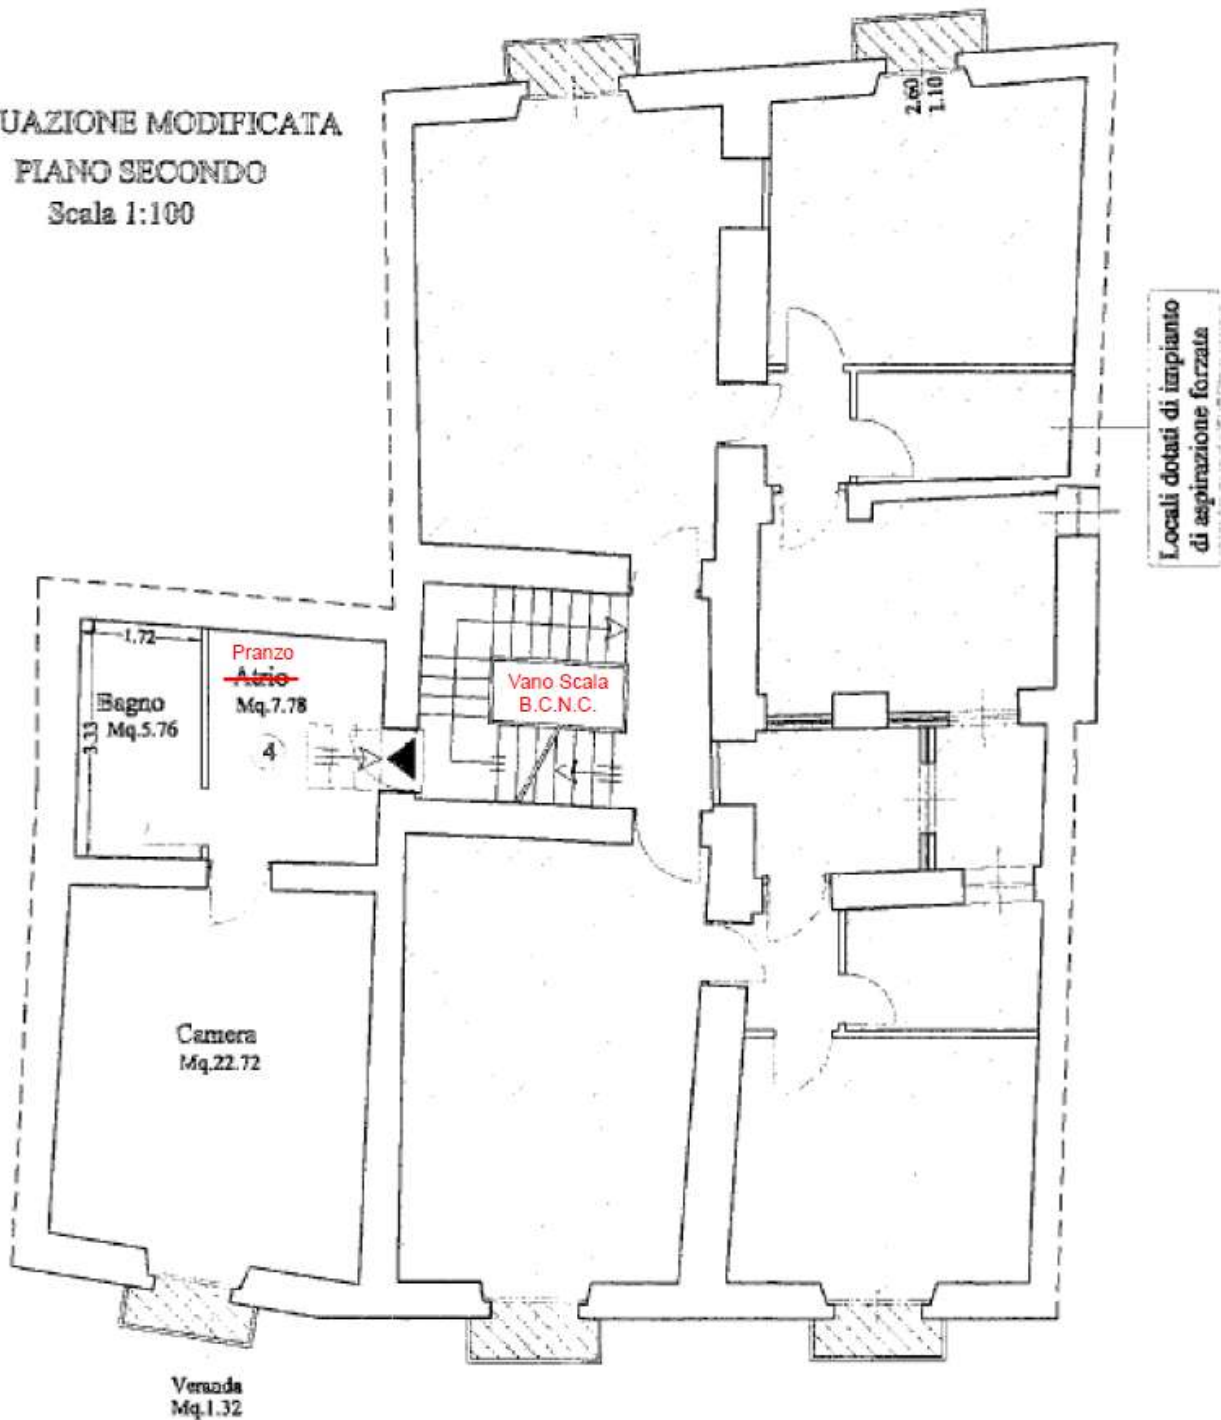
Stralcio dell'ultimo progetto approvato. Aut. Ed. n. 105/2007 (fuori scala). Secondo Piano
